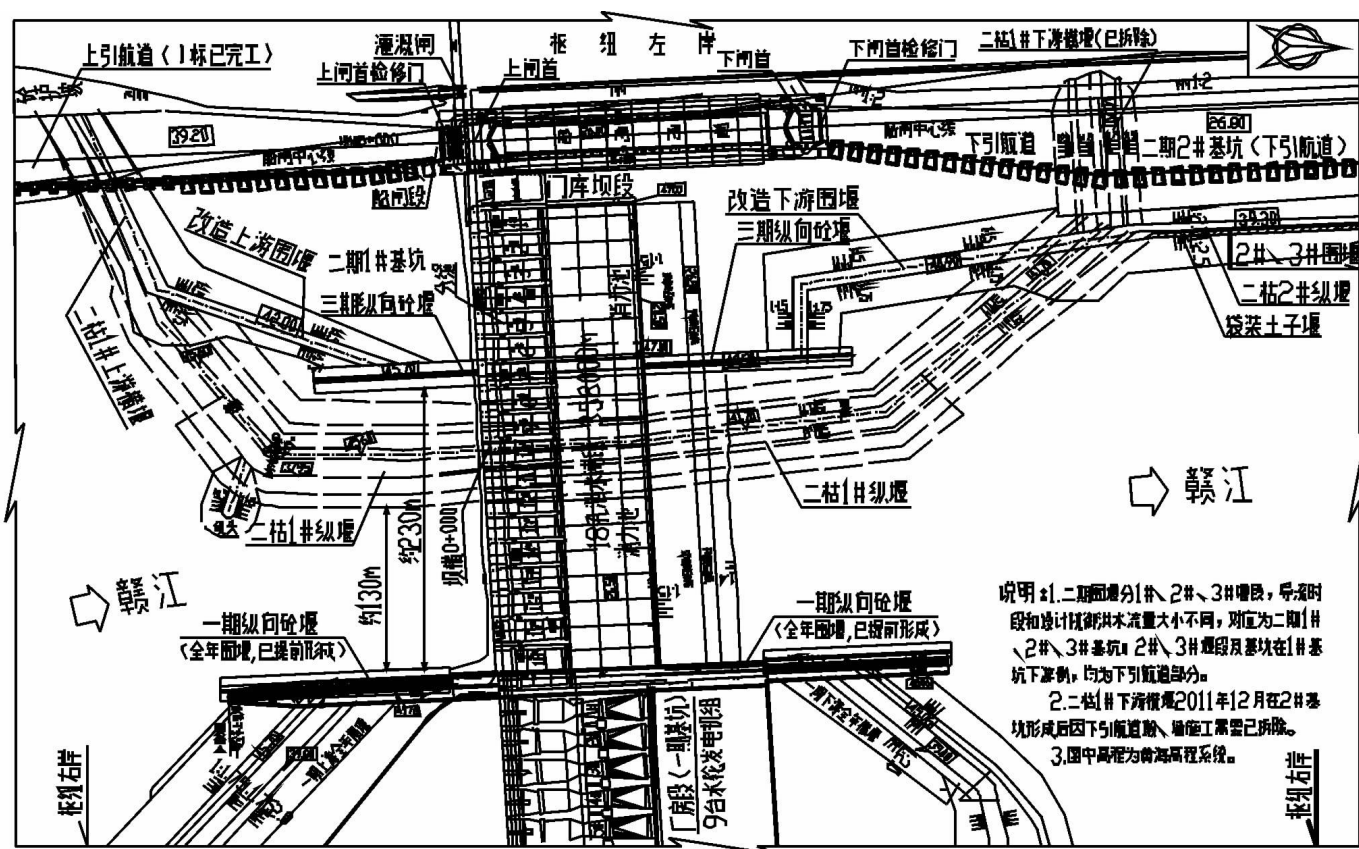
峡江水利枢纽二期工程施工平面布置图(局部)
